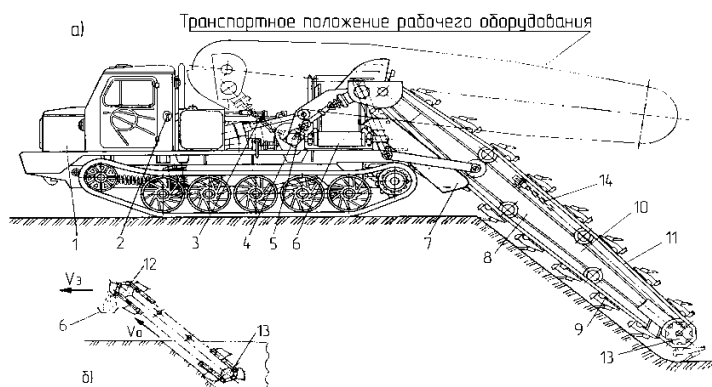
Экскаватор траншейный цепной: а) - общий вид; б) - схема работы экскаватора: 1 - базовый трактор; 2 - органы управления; 3 - гидросистема; 4 - распределительная коробка; 5 - механизм подъема-опускания рабочего органа; 6 - отвальный конвейер; 7 - лоток; 8 - рабочий орган; 9 - скребки; 10 - рама рабочего органа; 11 - цепи длиннозвенные; 12 - ведущие звездочки; 13 - натяжные звездочки; 14 - цепные откосообразователи
